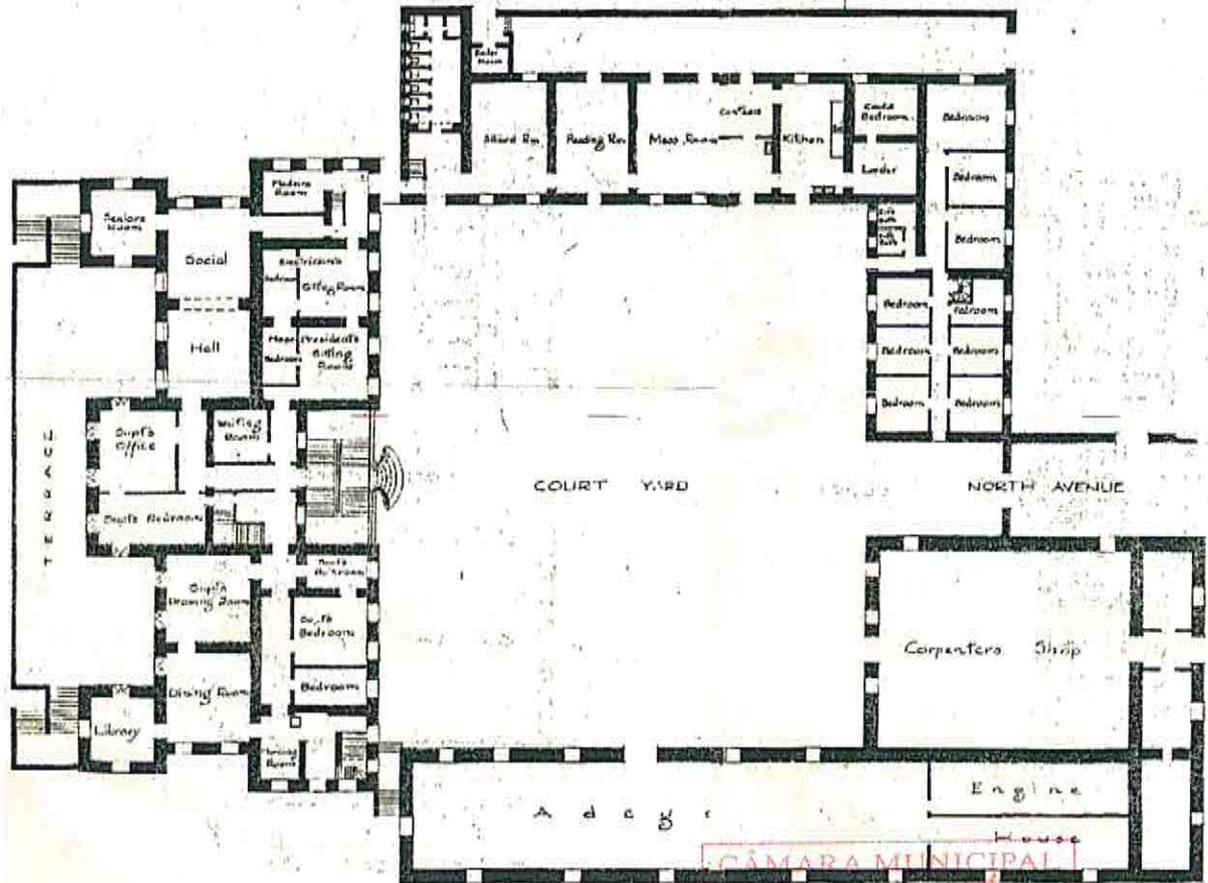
Planta do Pátio (princ.º Sec XX)
